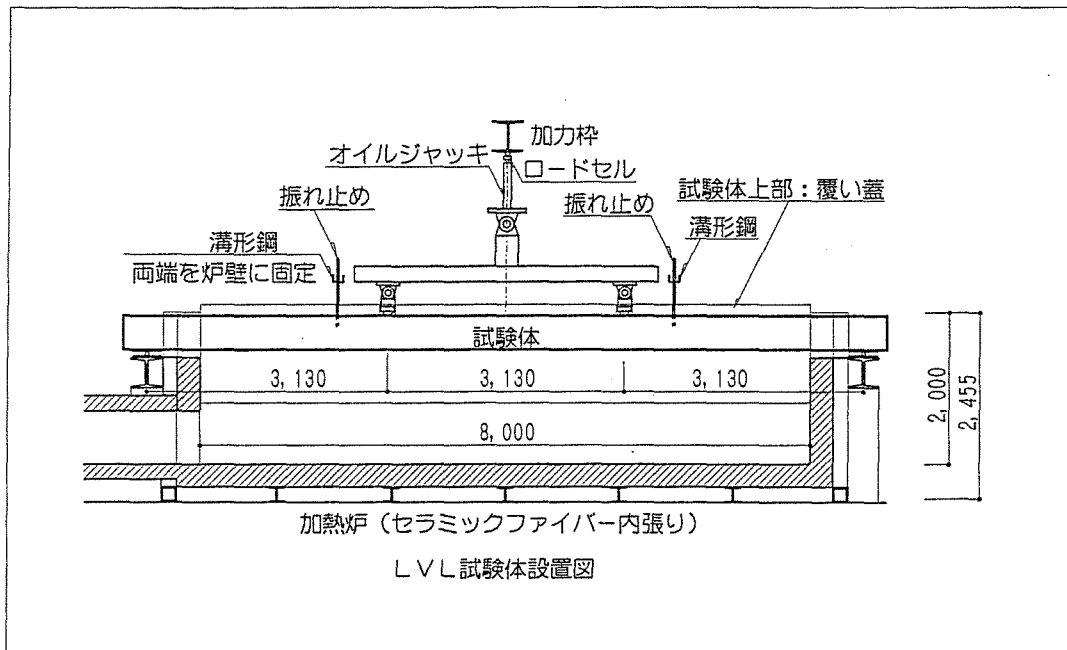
試験体水平炉設置図 (加熱長：8 m)
